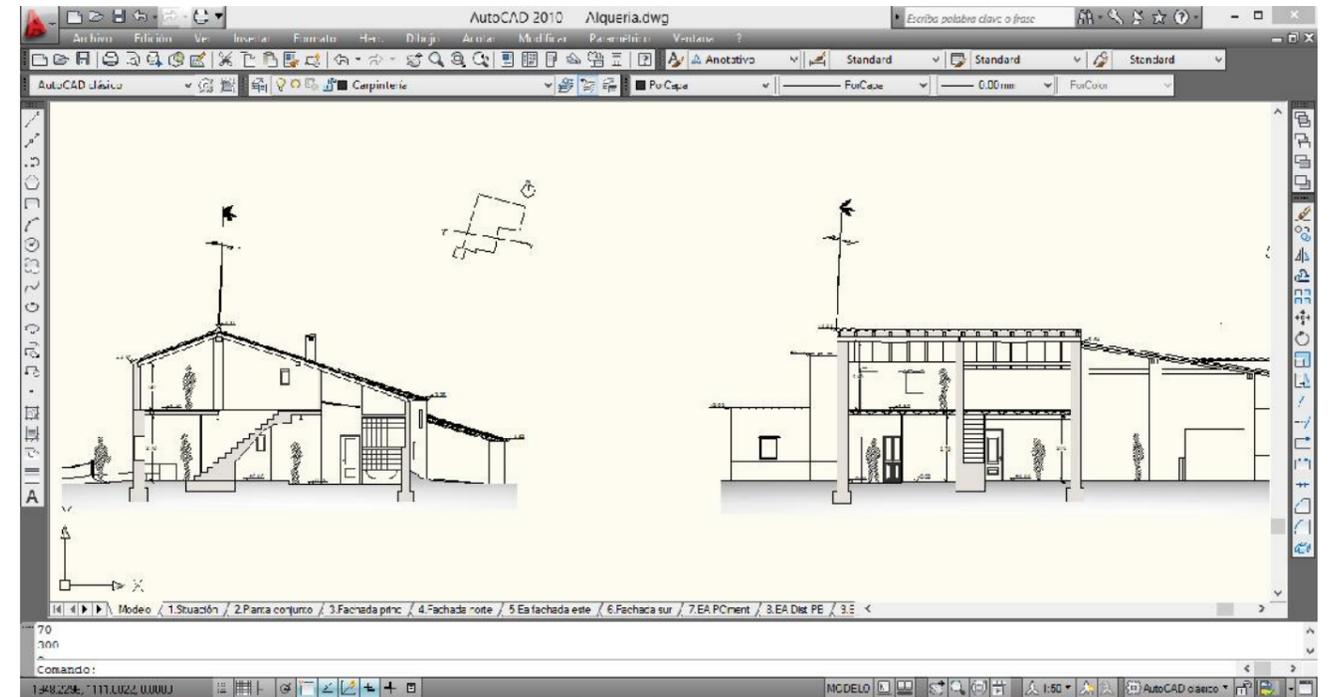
Levantamiento gráfico inmueble. Fuente: propia autora
